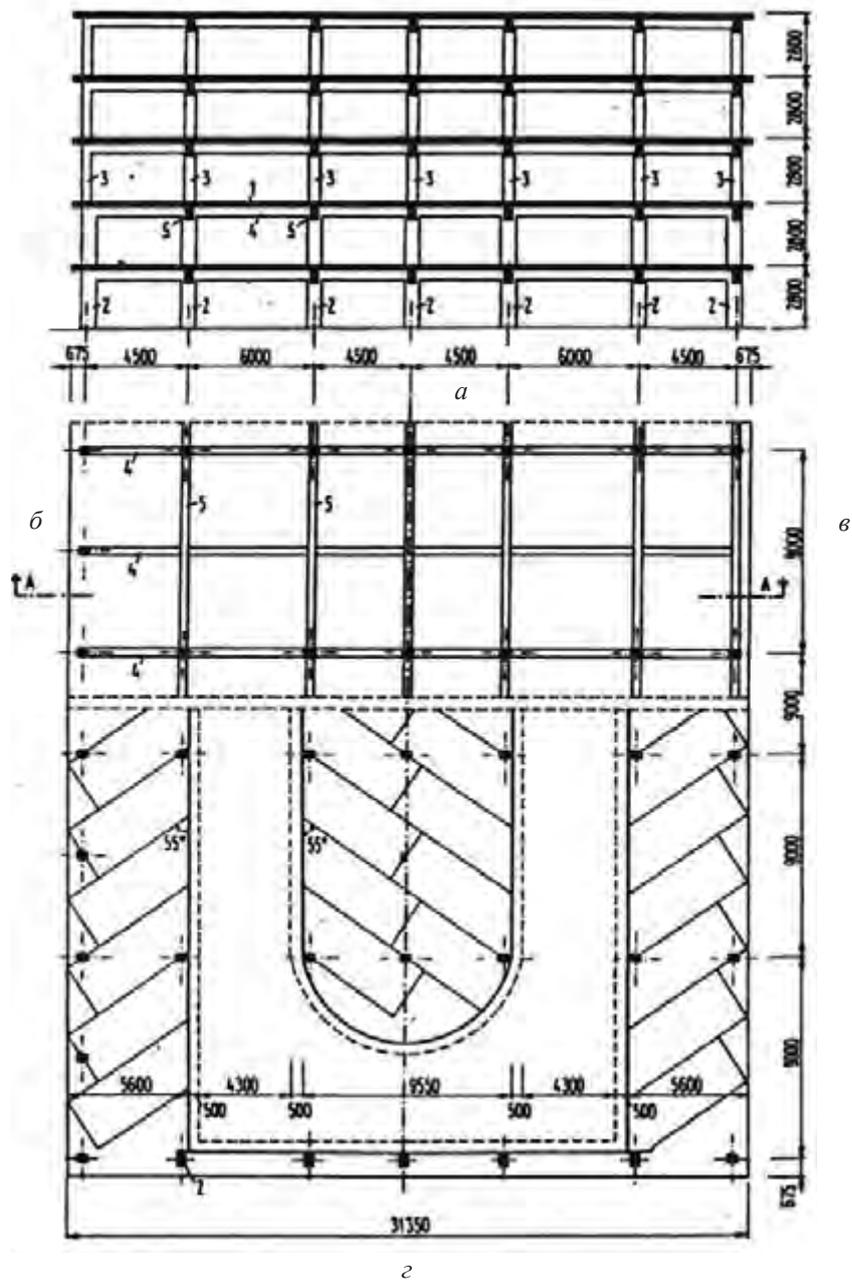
Варианты косоугольной расстановки автомобилей: *a* — схема разреза; *б* — план раскладки плит перекрытия, несущих балок и ригелей (1 вариант); *в* — план раскладки плит перекрытия, несущих балок и ригелей (2 вариант); *г* — план сетки колонн; 1 — плиты перекрытия; 2, 3 — колонны; 4, 5 — балки и ригели
